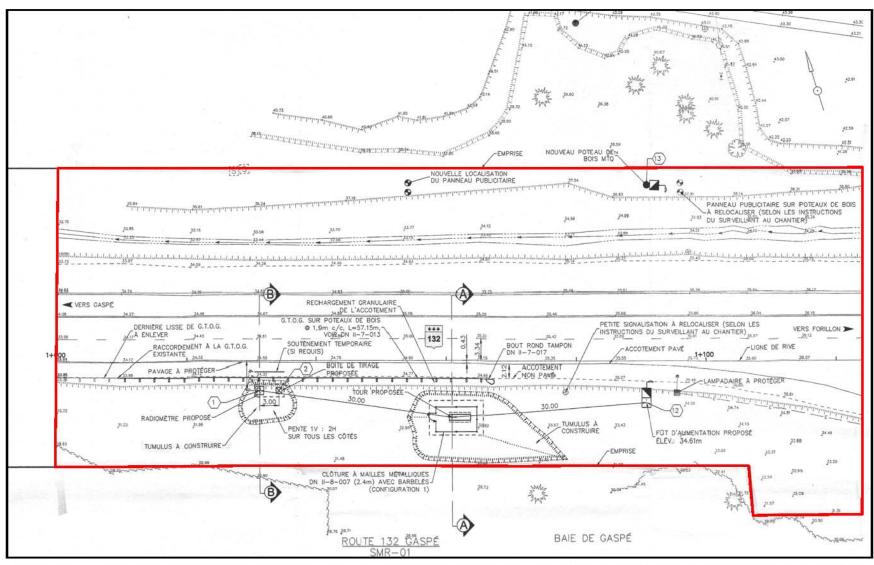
Localisation du secteur inventorié, projet n° 154-09-0296 (source : Ministère des Transports, plan d'ensemble [extrait], Implantation massif, chaussée, et construction SMR-01 – 1 de 2, Plan EL-10-1-02300 (6/23), 24 mars 2010)
